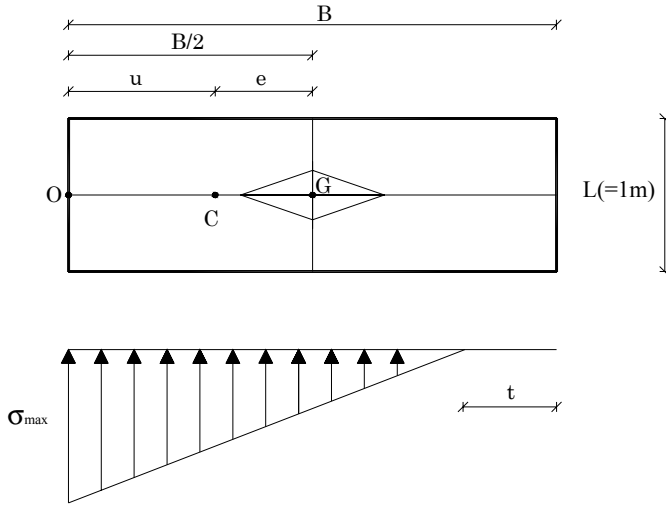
Centro di pressione esterno al nocciolo centrale d'inerzia.
